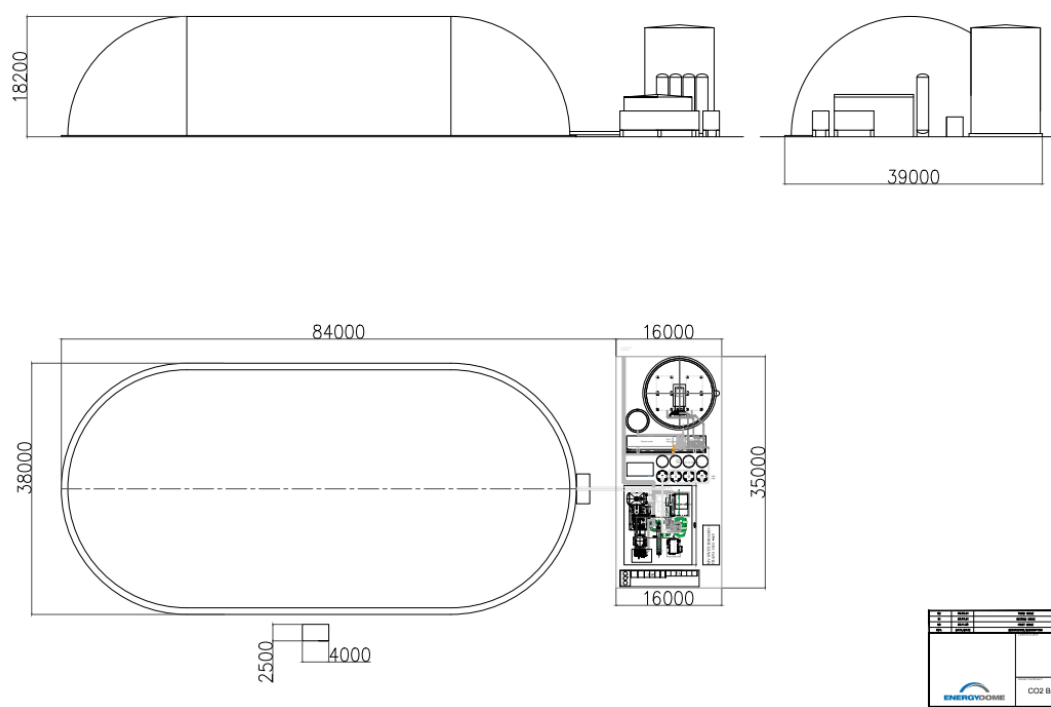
Pianta e viste prospettiche dell'impianto pilota CO2 Battery
